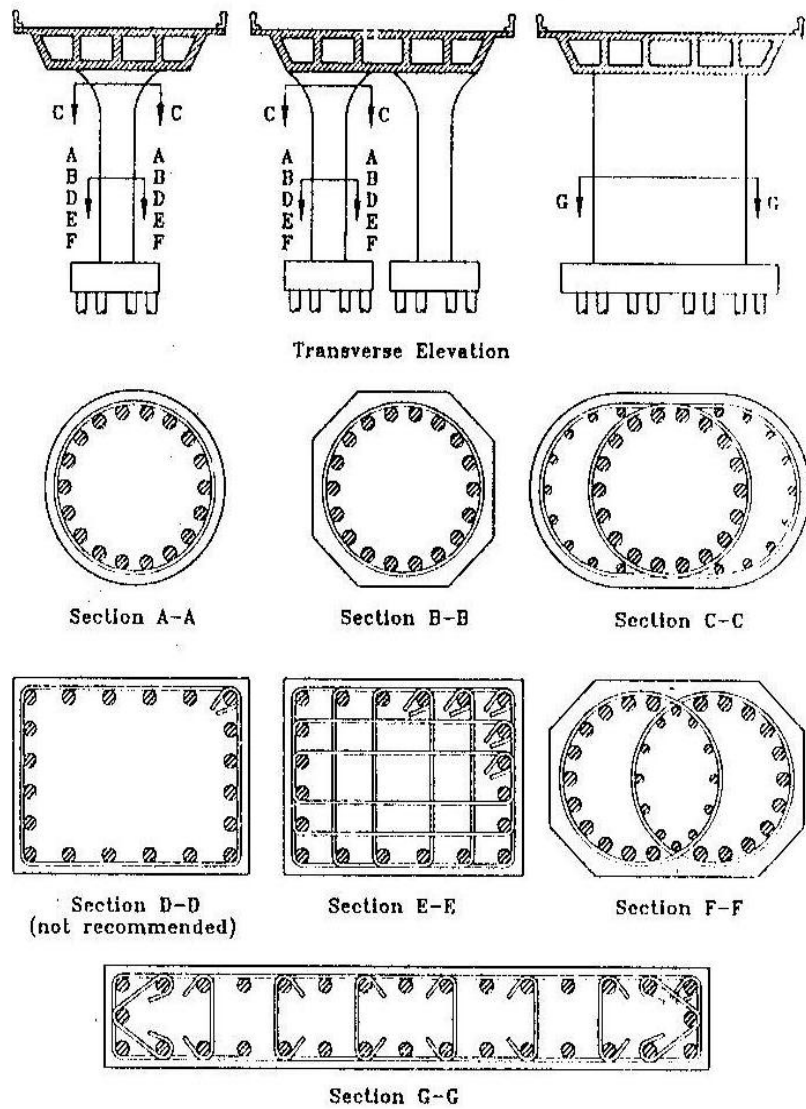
Secciones de columnas sólidas. (Tomado de Priestley, Seible y Calvi 1996)
